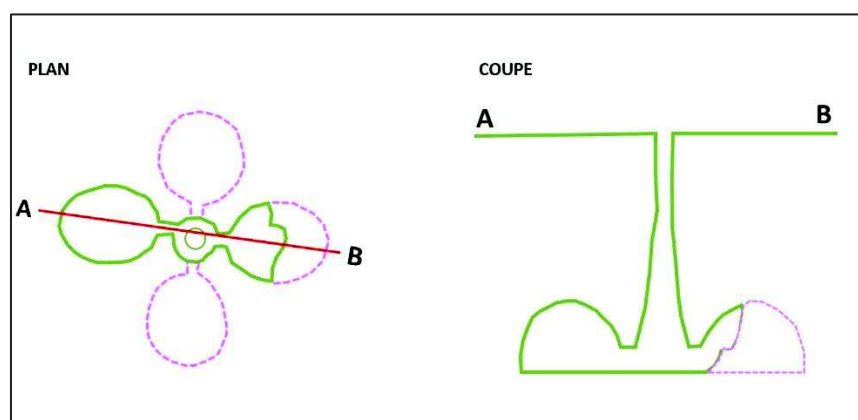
Illustration d'une marnière en plan (à droite) et en coupe (à gauche)
